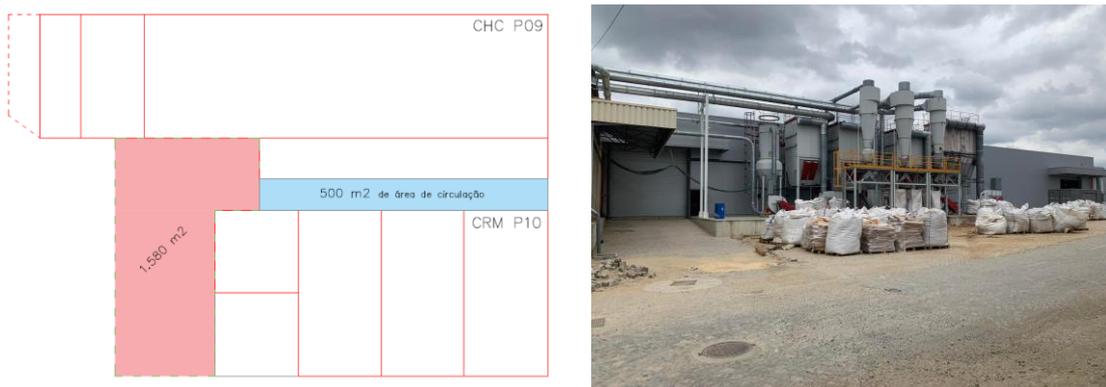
Layout* das unidades industriais de CHC e CRM atualizado (à esquerda) e fase final de construção do novo pavilhão
